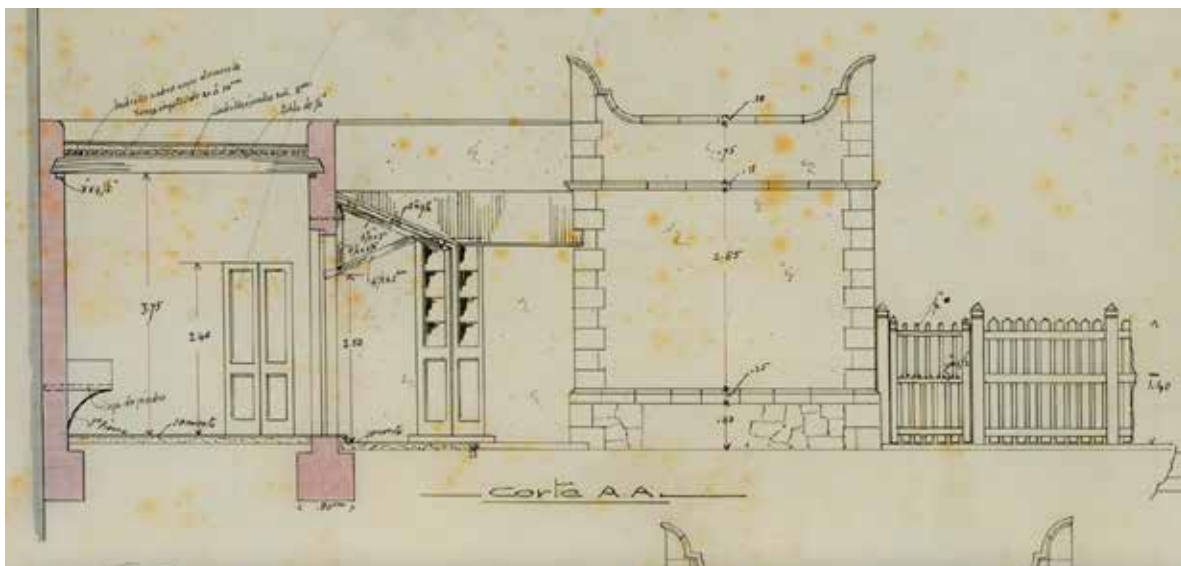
Detalle de la fachada de la Estación de Santa Cruz Tlaxcala. Autoría y autorización para reproducción:
